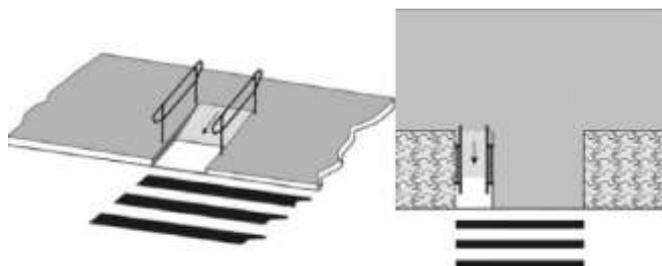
Вариант размещения пандусов на отнесенных пешеходных переходах, располагаемых на перегонах
